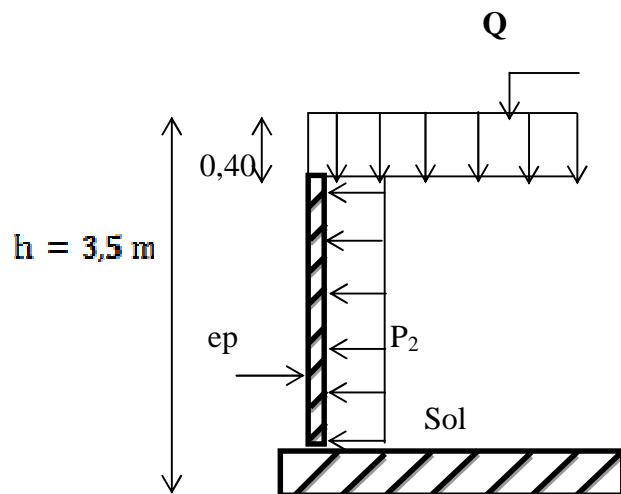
dimensions et chargement d'un voile de soutènement
